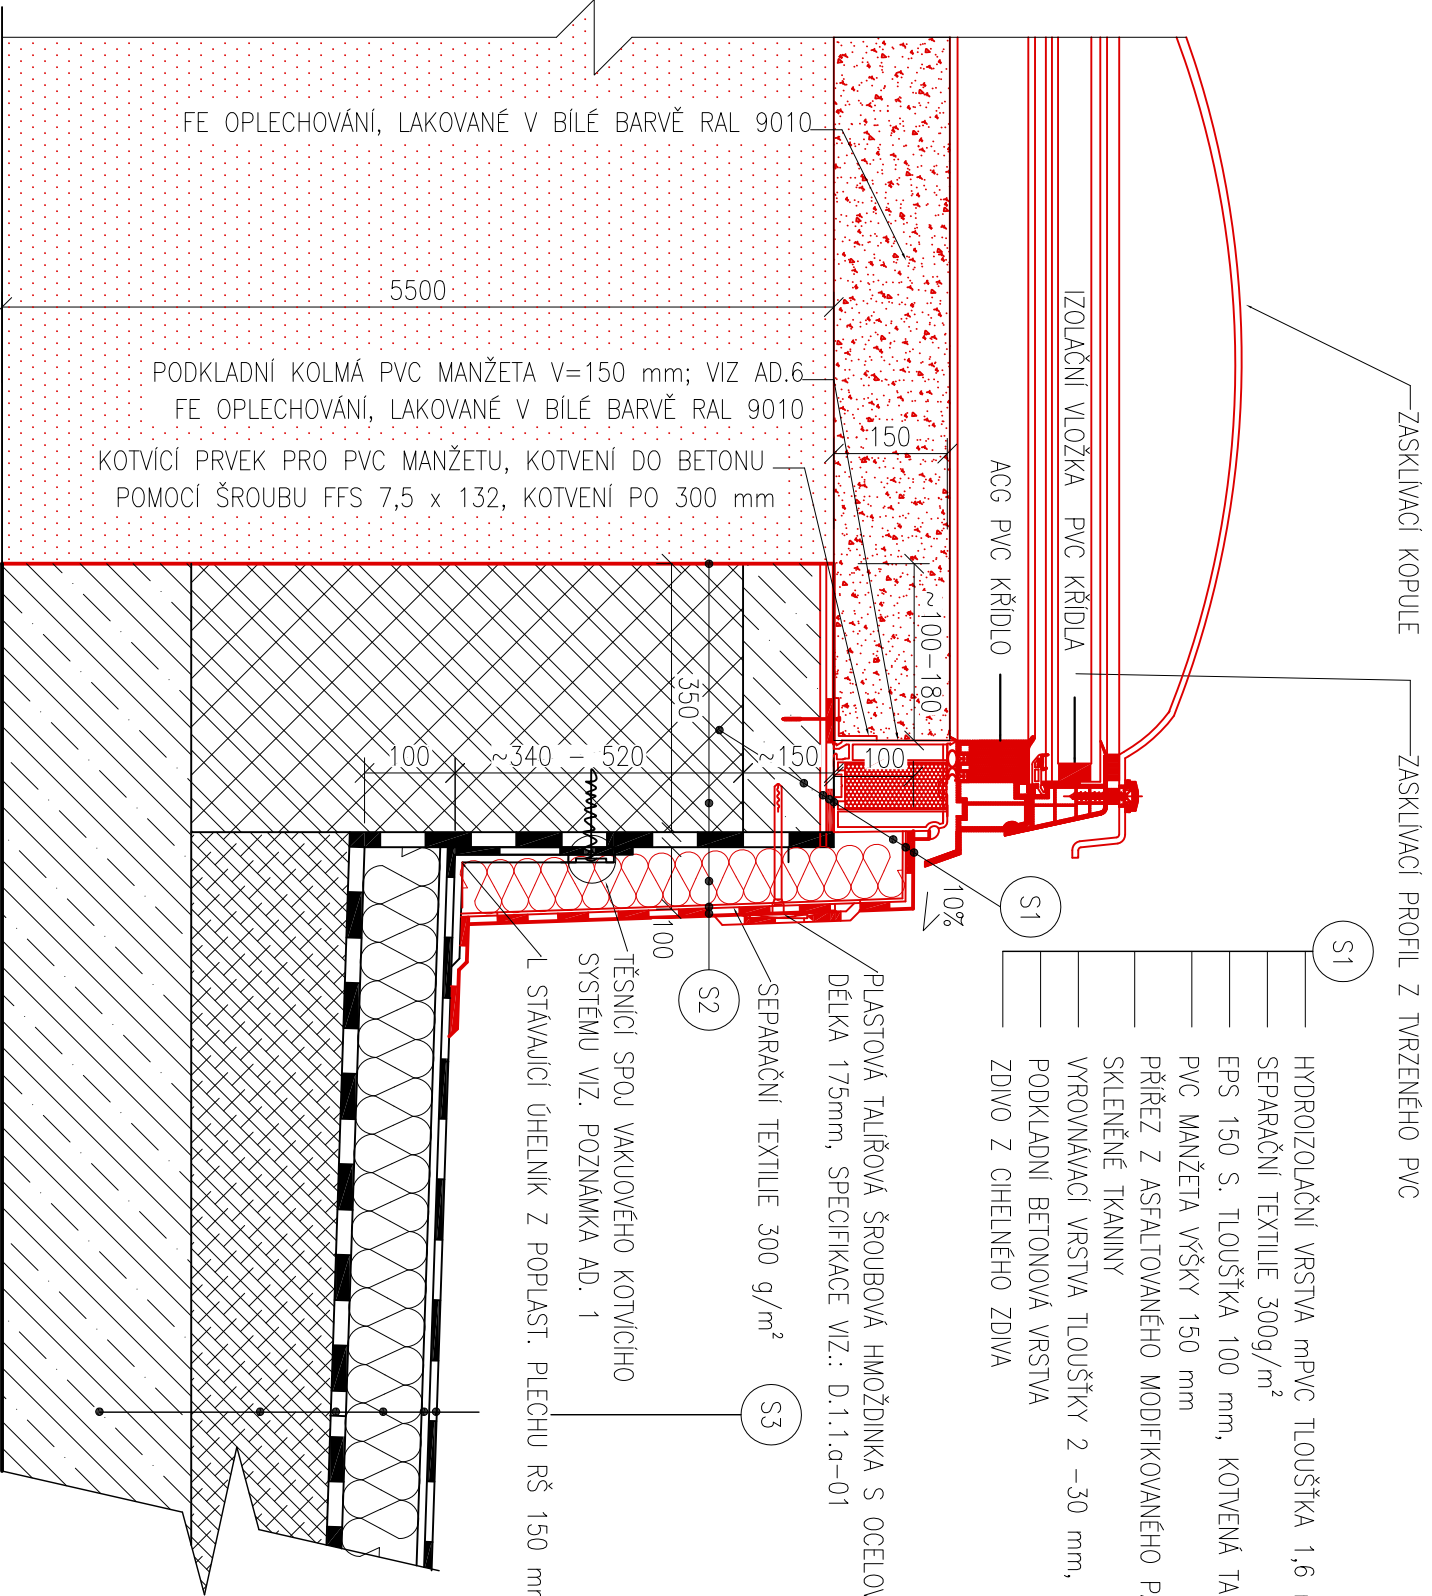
DETAIL “B” OPRAVY STŘEŠNÍHO SVĚTLÍKU – NAVRŽENÝ STAV
